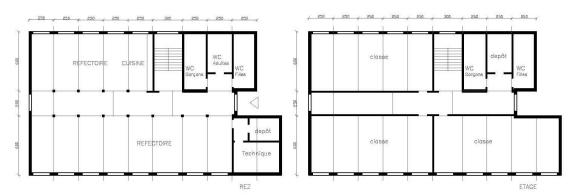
Plans de principe des pavillons scolaires modulaires
